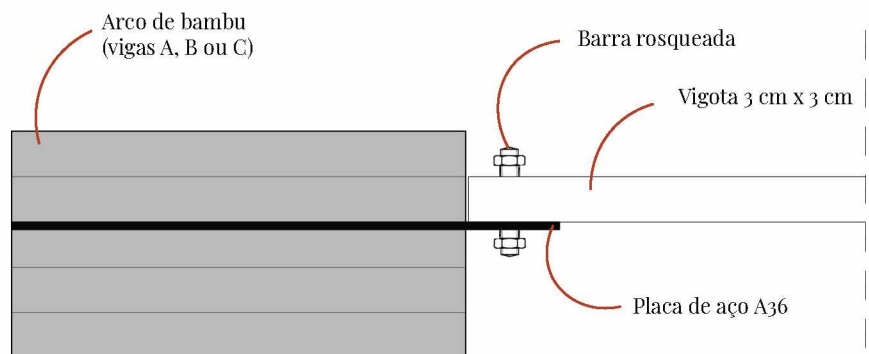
Detalhe Encaixe Vigas e Vigotas. Escala 1:5. Fonte: Elaborado pela autora.
